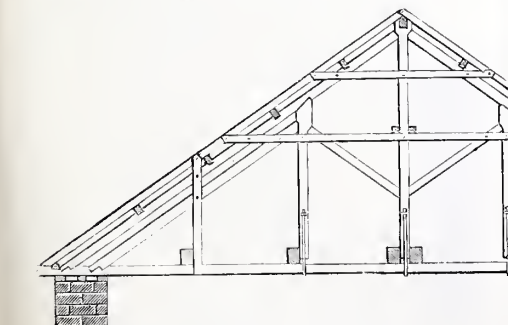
Dach mit fünf säuligem Hängewerk.
